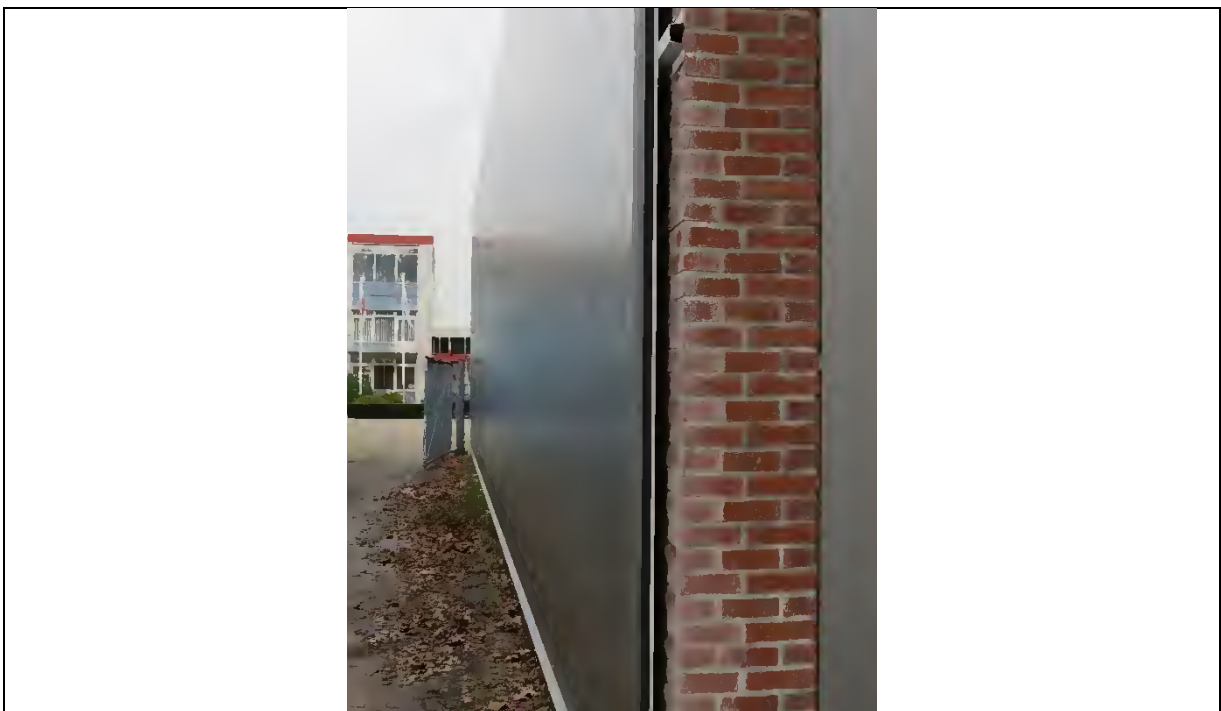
Massive Fassade nach Montage der Sandwichelemente
